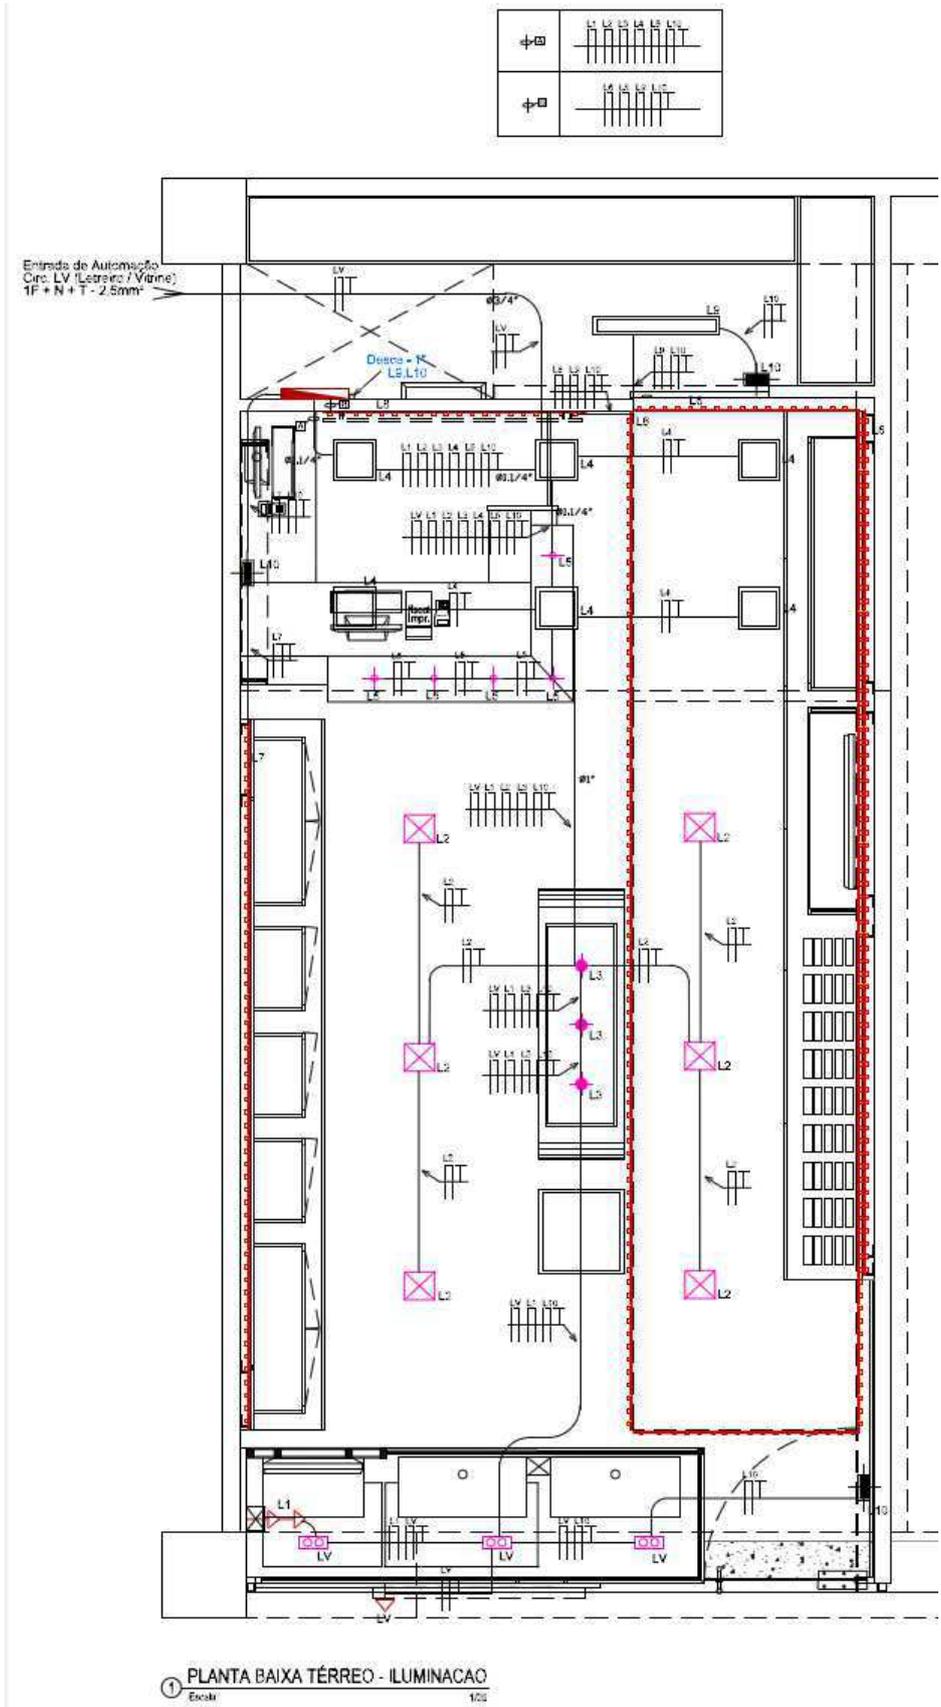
Planta baixa com projeto de iluminação do térreo da loja Watt
